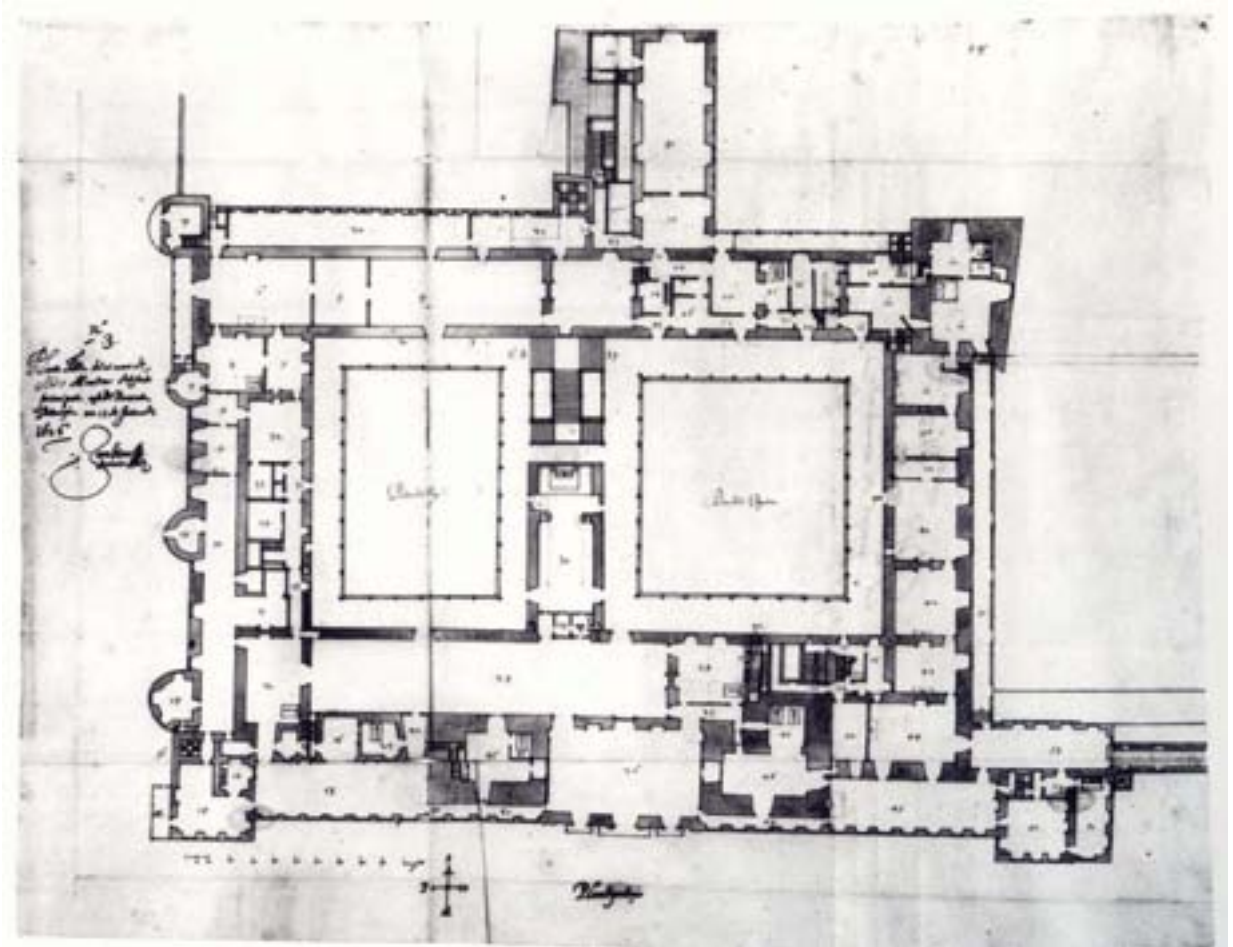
JUAN GÓMEZ DE MORA. 1626 Planta principal del Alcázar. Biblioteca Vaticana
